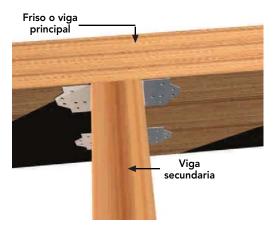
48: Conector de acero galvanizado de 1,7 mm de espesor utilizado para unir friso con vigas maestras de piso o entrepiso. Soporta bien las fuerzas paralelas y perpendiculares que puedan recibir las vigas maestras.
